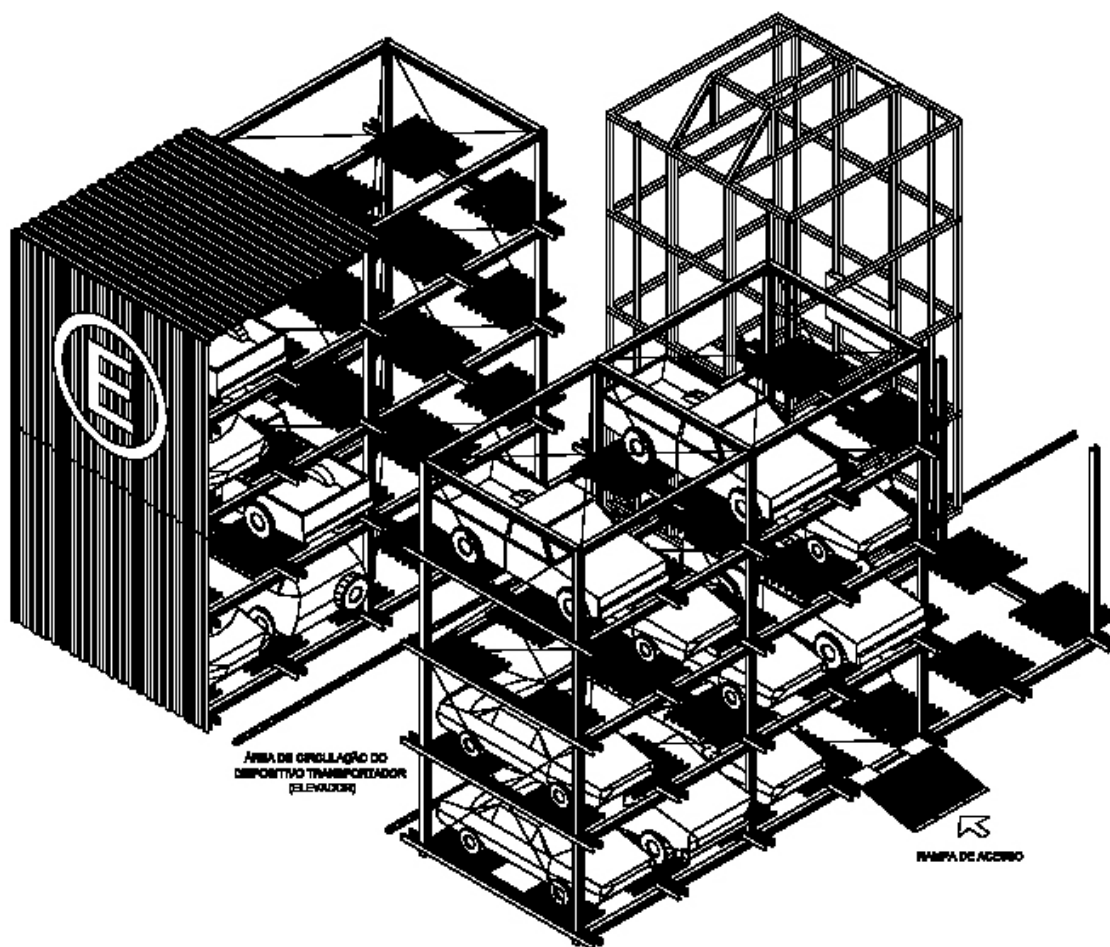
Sistema de estacionamento vertical modulado em estrutura metálica. Estudo comparativo em um lote típico da região central de Belo Horizonte. Módulos.
